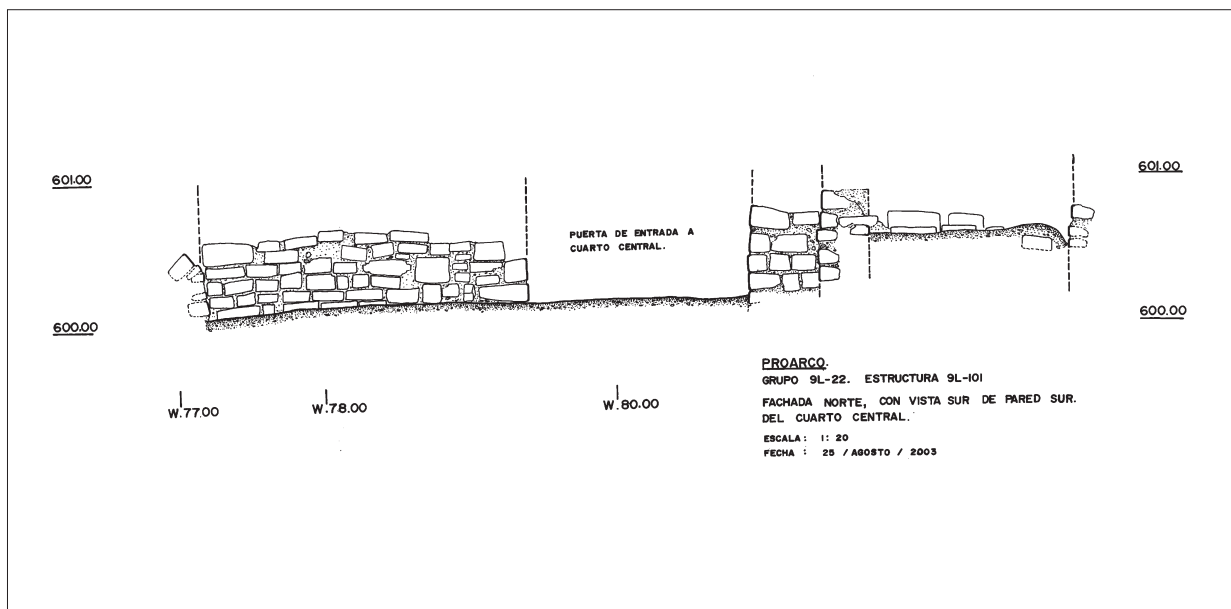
Fachada interior del cuarto central de 9L-101-1^a, vista al sur
